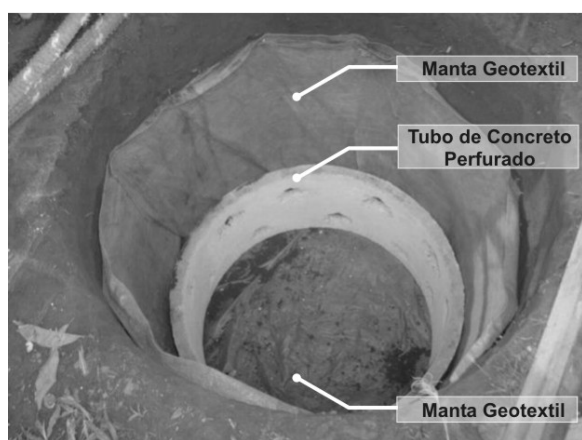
Instalação dos tubos de concreto sobre a manta geotêxtil
